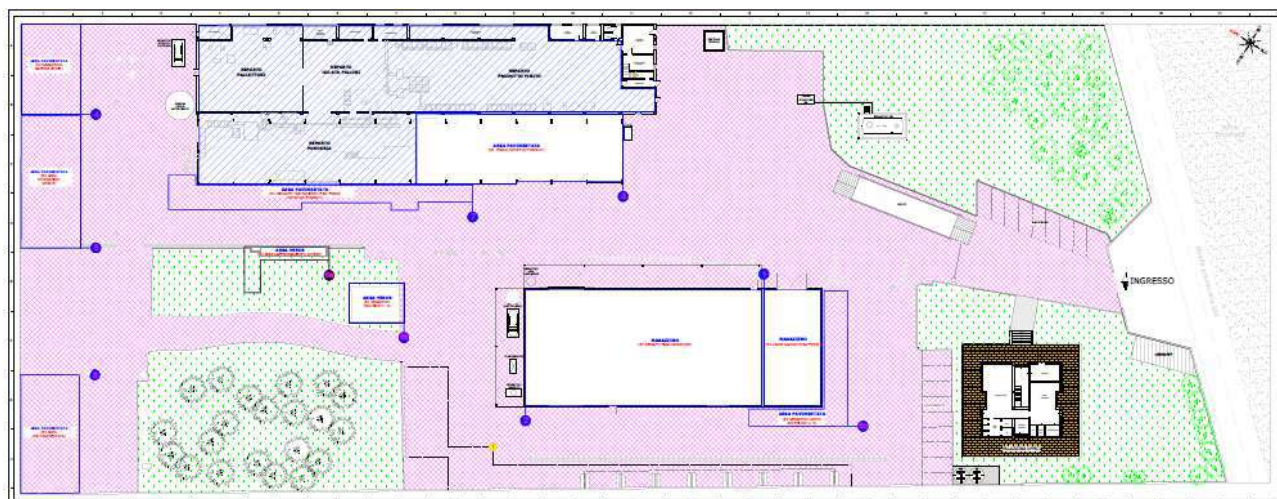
Planimetria Generale di Stabilimento, Aree Interne ed Esterne – Immagine fornita dalla Committente
